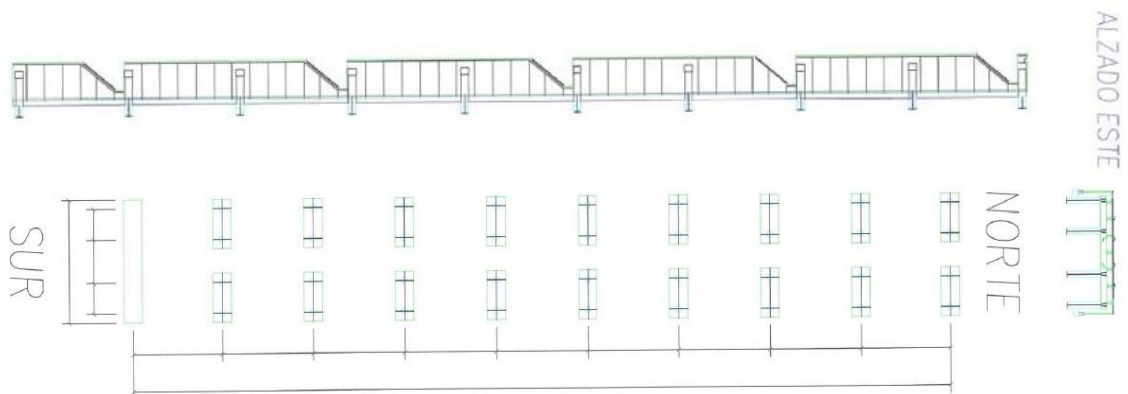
Planta, alzado oeste y secciones del documento "as built"
